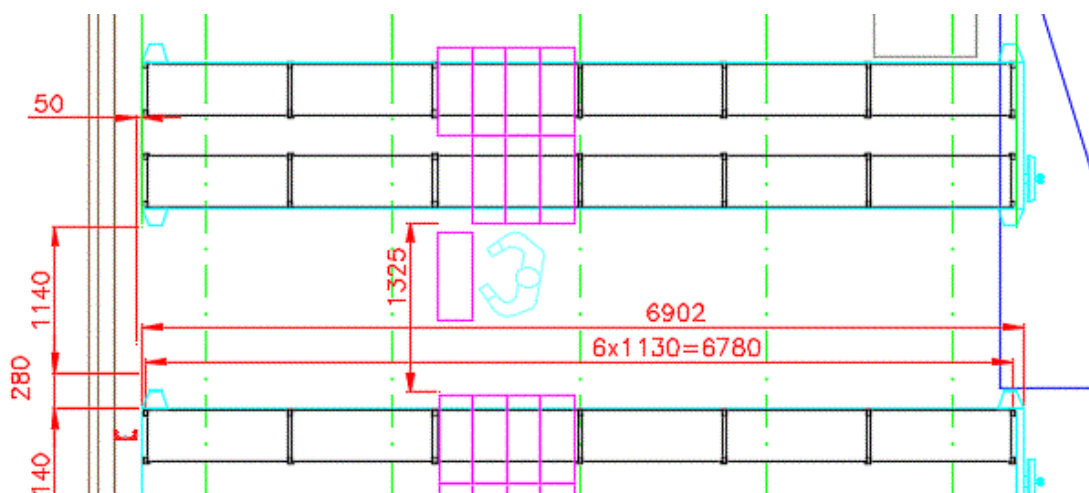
CAD výkres pro pojízdné regály v poli B [Autor]
